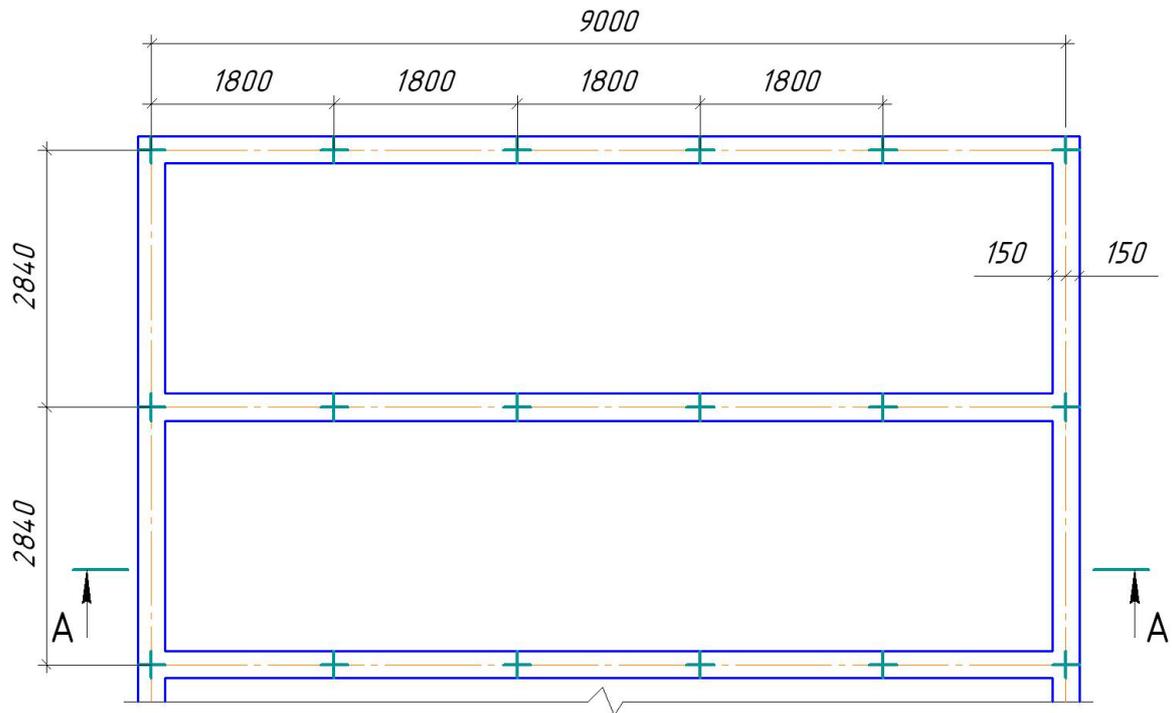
Схема плана ростверка под модульное здание длиной 9 м
